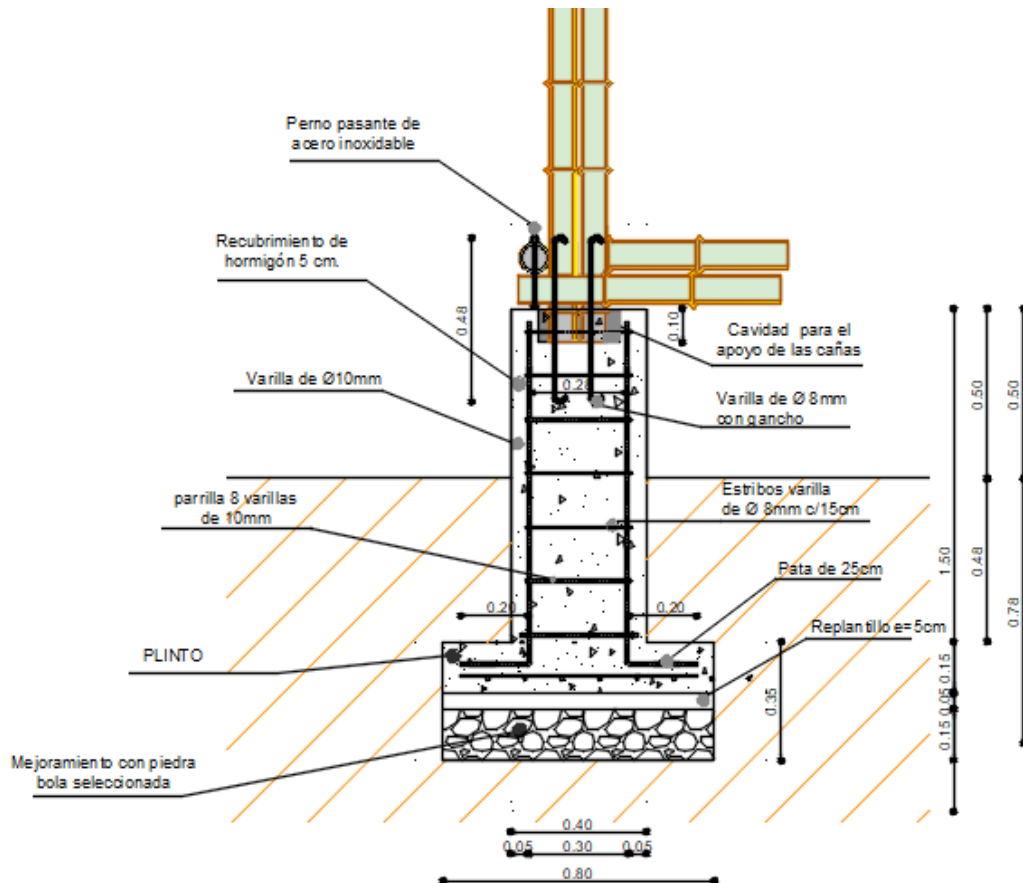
Tipos de anclajes en caña utilizados en la propuesta.
